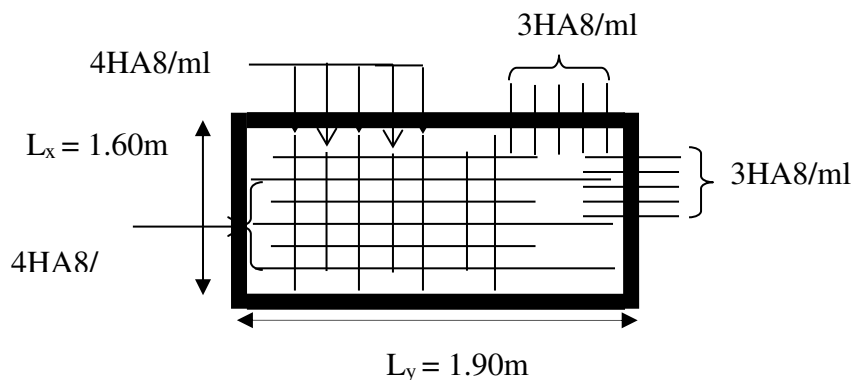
Schéma de ferrailage de la dalle du locale des machines.
